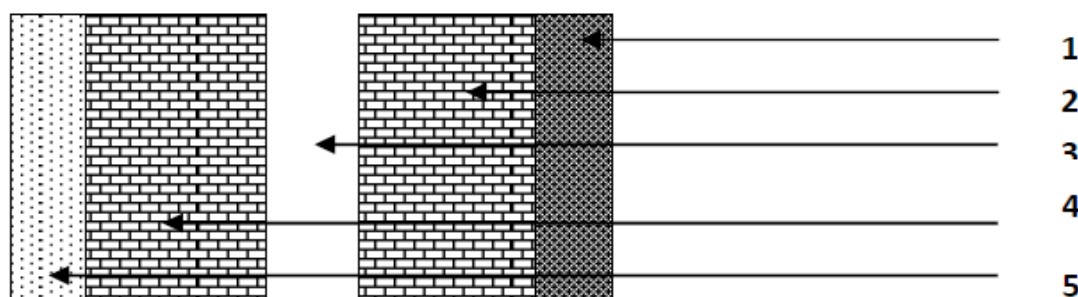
Coupe verticale d'un mur extérieur Elles se résument dans le tableau suivant :
